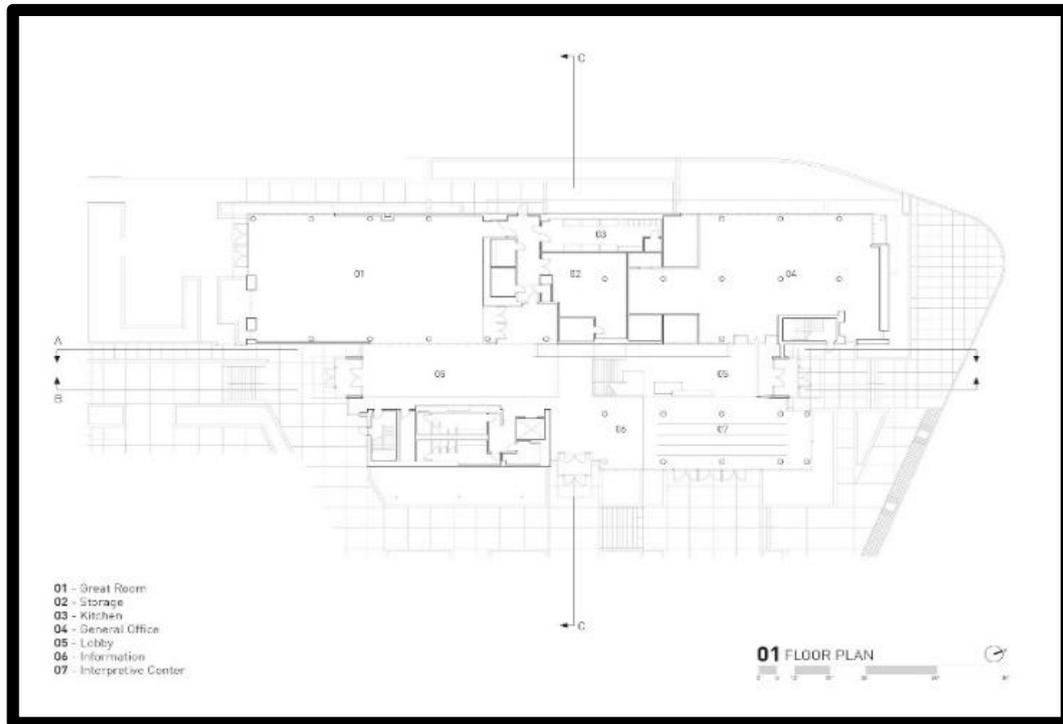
Centro Alumni / TVA Architects Planta principal. Recuperado de la pag. Web Archdaily
